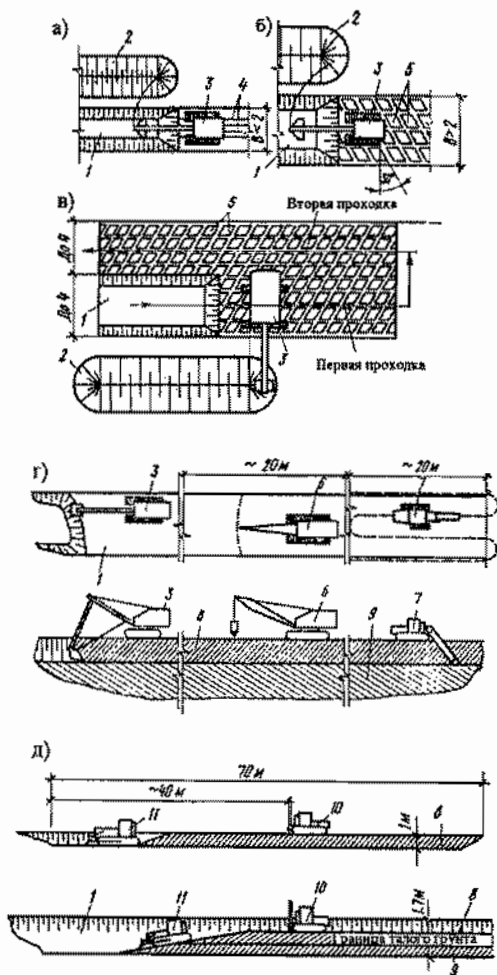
Разработка траншей в мерзлых грунтах с предварительным их рыхлением: а - шириной до 2 м с нарезкой продольных щелей; б - шириной более 2 м с нарезкой косягольных блоков; в - то же, шириной 8 м за две проходки экскаватора; г - разработка траншей коллектора баровой машиной, клин-бабой и обратной лопатой; д - разработка траншеи машиной ударного действия М-1-28 и бульдозером; 1 - траншея; 2 - отвал; 3 - экскаватор с обратной лопатой; 4 - продольные прорезы; 5 - нарезанные блоки; 6 - клин-баба; 7 - баровая машина; 8 - мерзлый грунт; 9 - талый грунт; 10 - машина М-1-28; 11 - бульдозер
